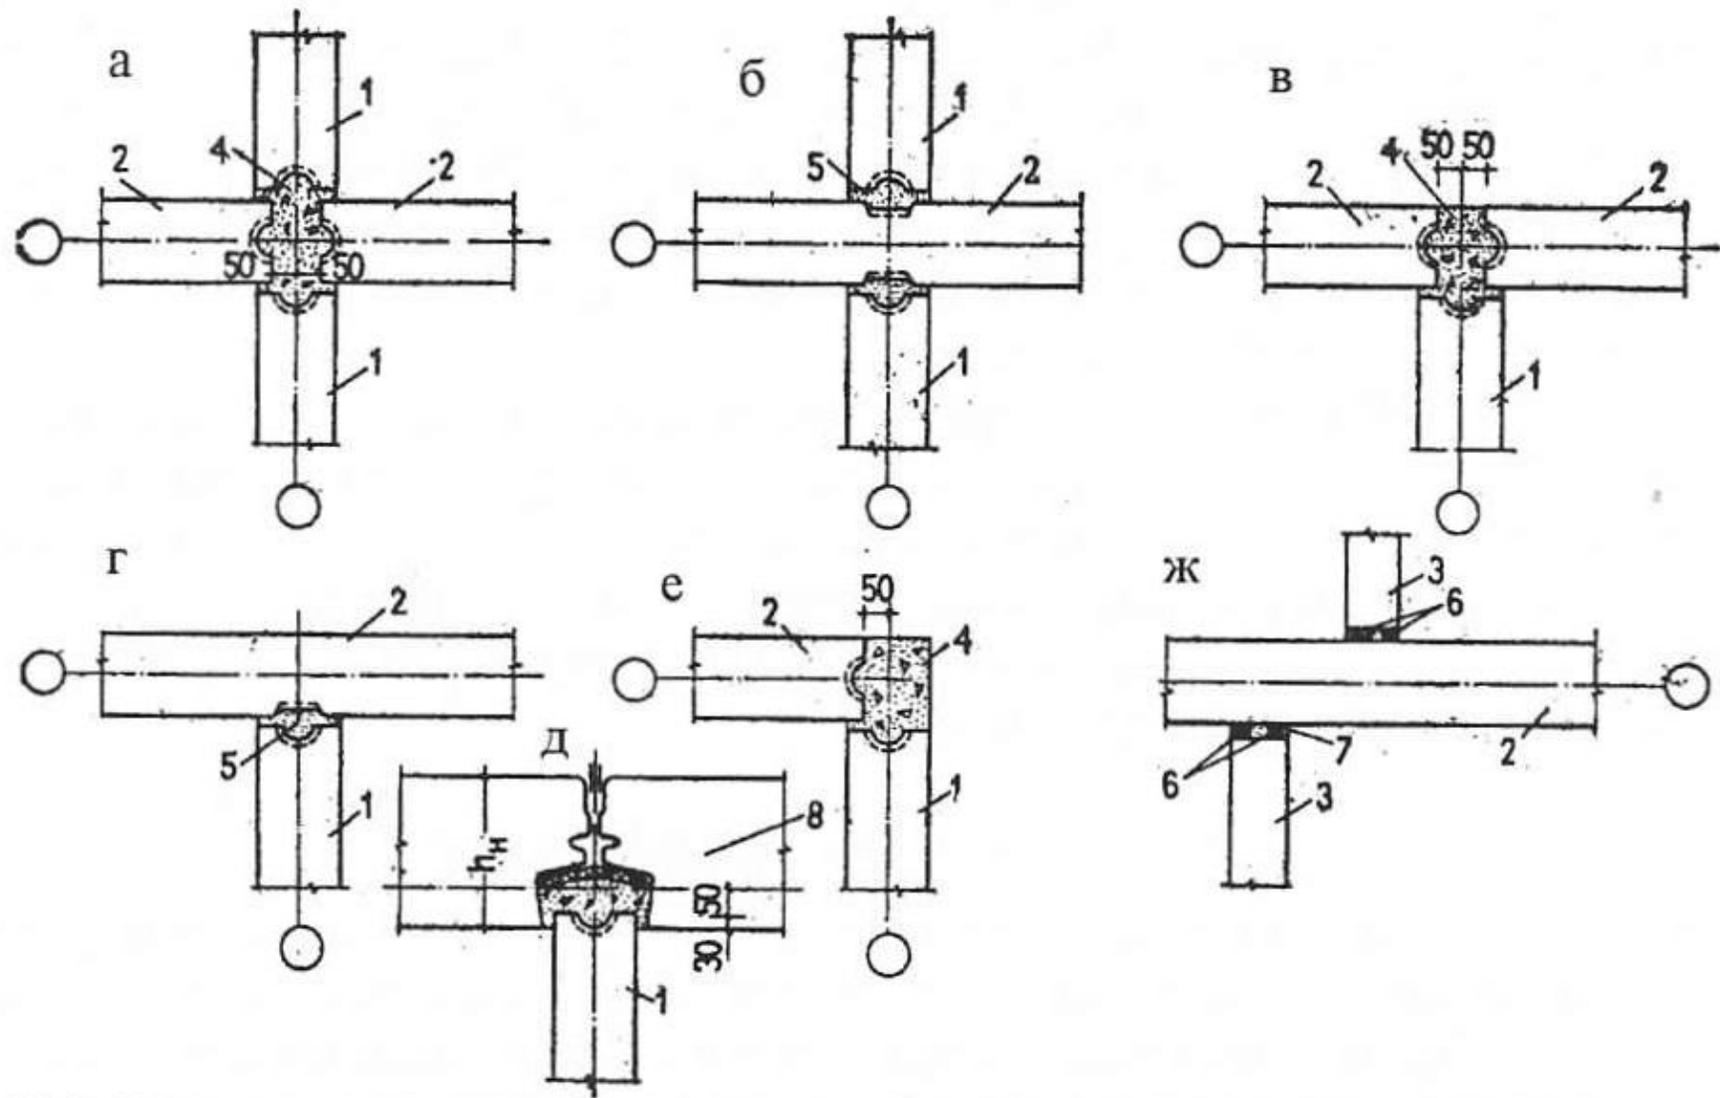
Вертикальные стыки бетонных панелей внутренних стен и перегородок: а – е – стыки несущих панелей между собой и с наружной стеной; ж – стык ненесущих перегородок со стеновой панелью; 1 и 2 – панели поперечных и продольных внутренних стен; 3 – панель перегородки; 4 – бетон замоноличивания; 5 – шпоночные рифления стыковых граней панелей; 6 – упругие прокладки; 7 – цементно – песчаный раствор; 8 – панель наружной стены
